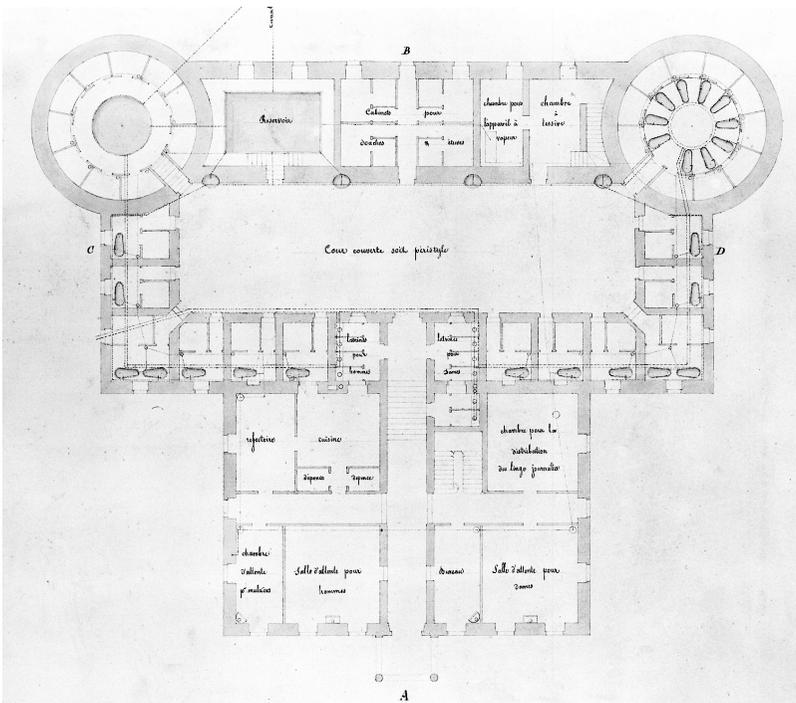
Lavey, projet de concours pour les bains par Charles Kinkelin, plan du rez-de-chaussée, 1835 (ACV).
